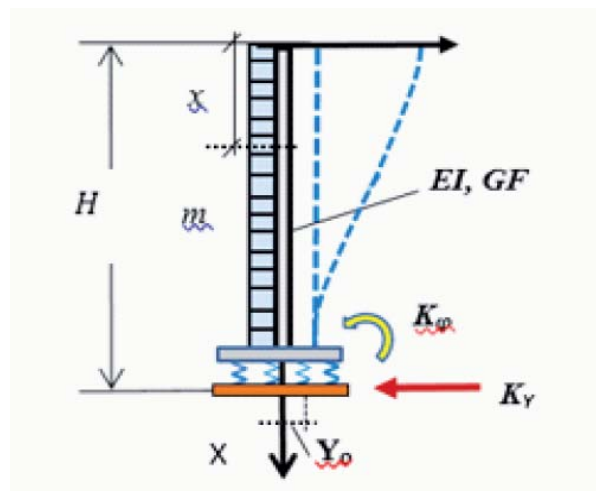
Динамічна розрахункова схема будівлі
